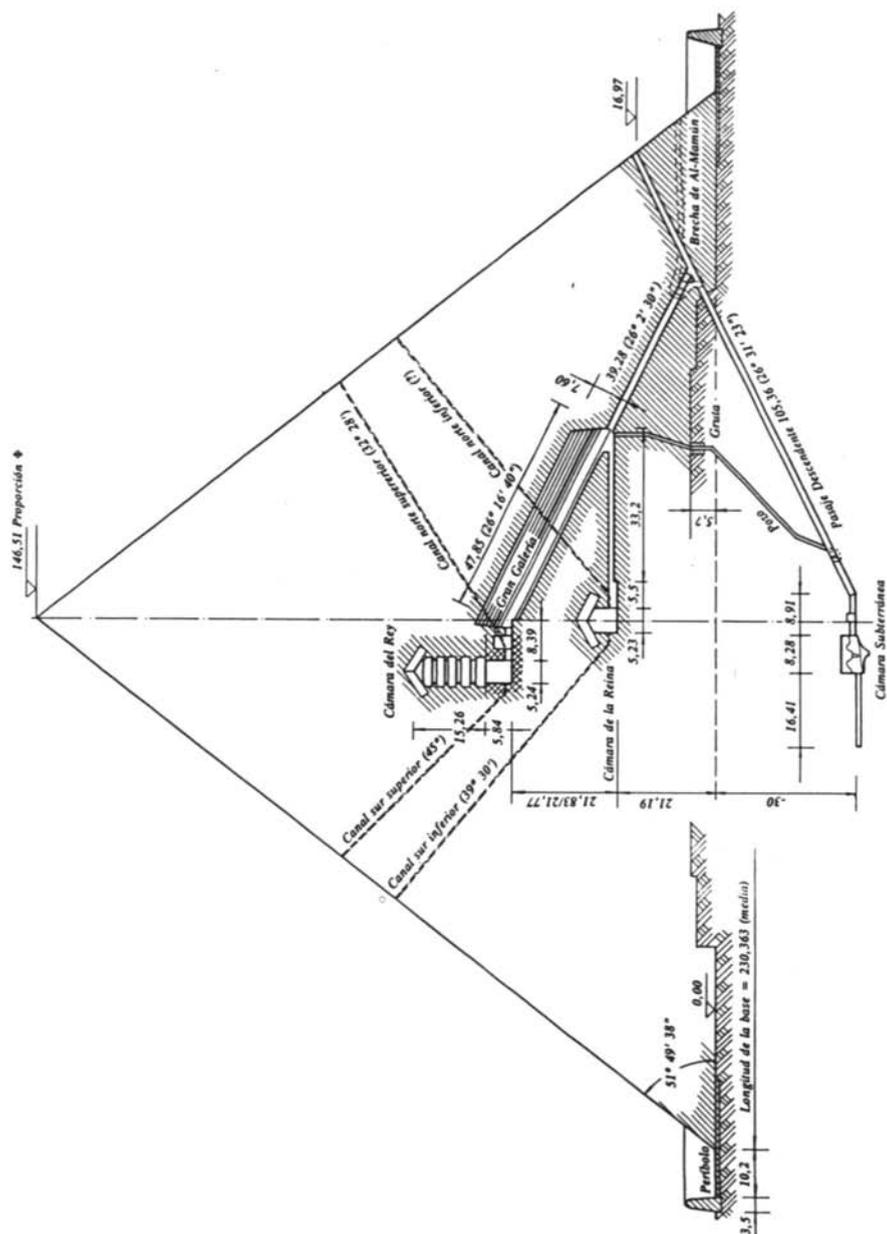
Vista en alzado y sección de la pirámide de Quéope
